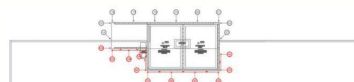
PLANTA DE BALANCINS - PAVTO TIPO 1º AO 11"
